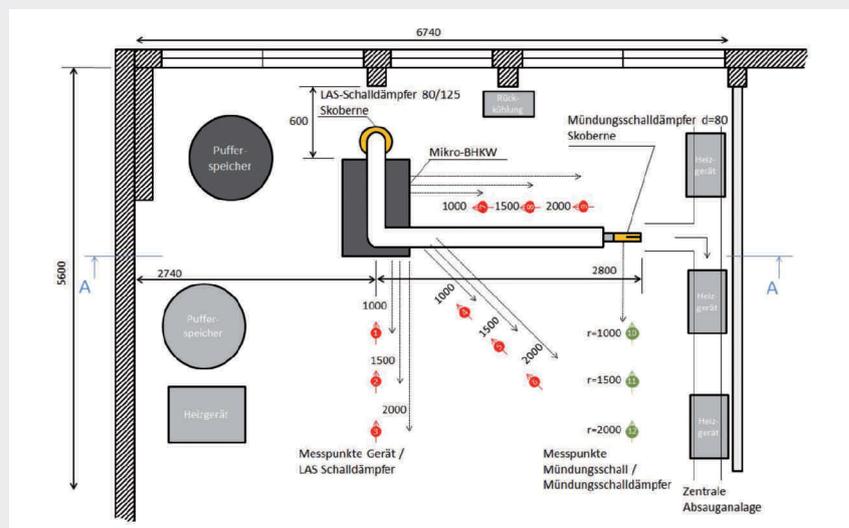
Grundriss Labor mit Anordnung BHKW, Speicher, Abgasführung und Messpunkten
